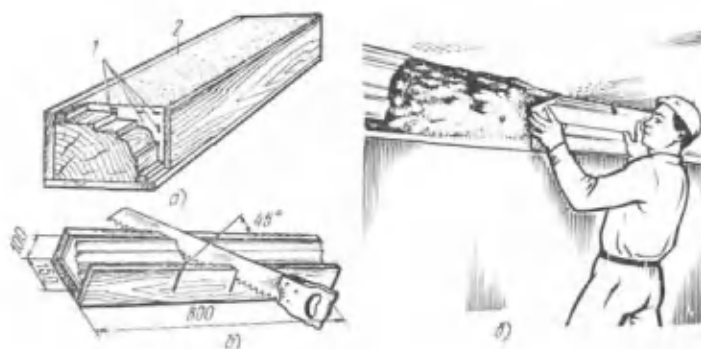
Установка сборных карнизов: а — форма для отливки, б — стусл, в — установка элементов карниза; 1 — драницы, 2 — гипсовый раствор
